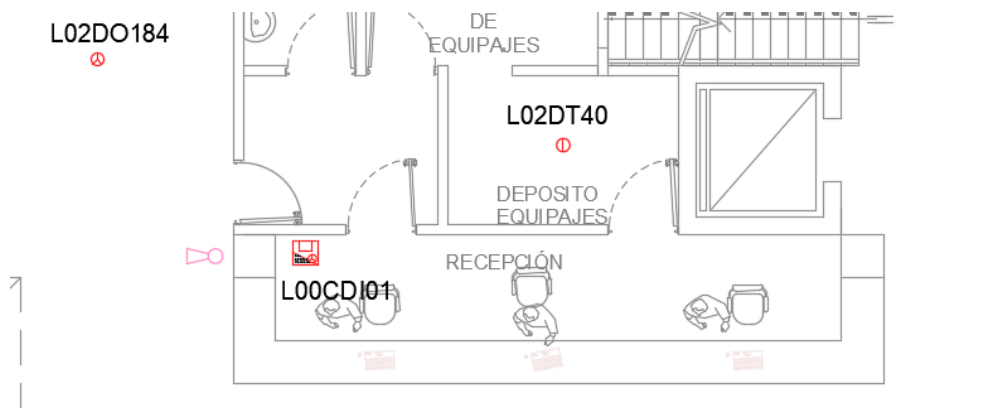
Emplazamiento central detección & alarma en recepción. Planta Baja. Planos del proyecto.
